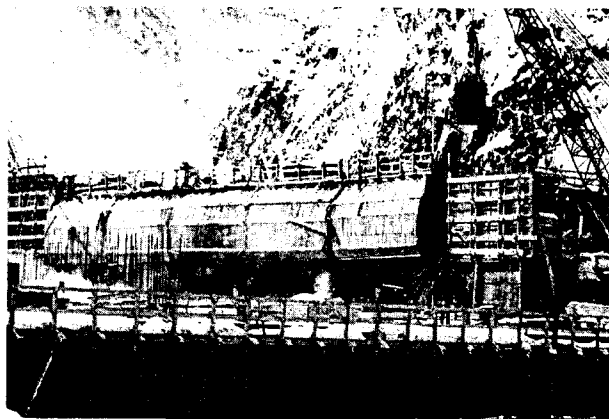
Укладка бетона в первом подвижном шатре на Бухтарминской ГЭС зимой 1957-58 года
